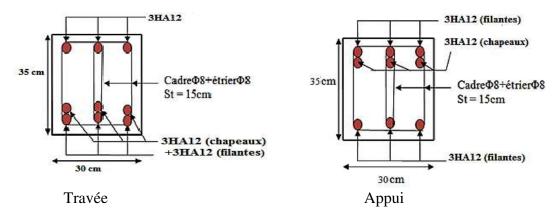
Schéma de ferraillage des poutres secondaires de RDC – 7 étages.
